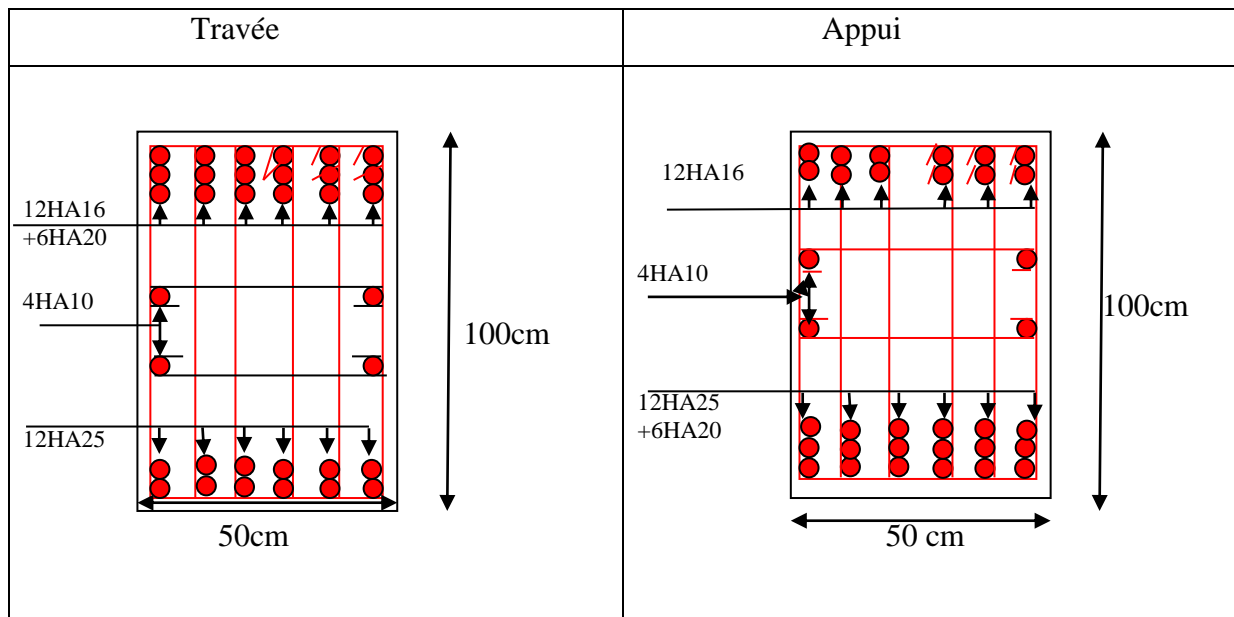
Schémas de ferrailages de la poutre de rigidité
